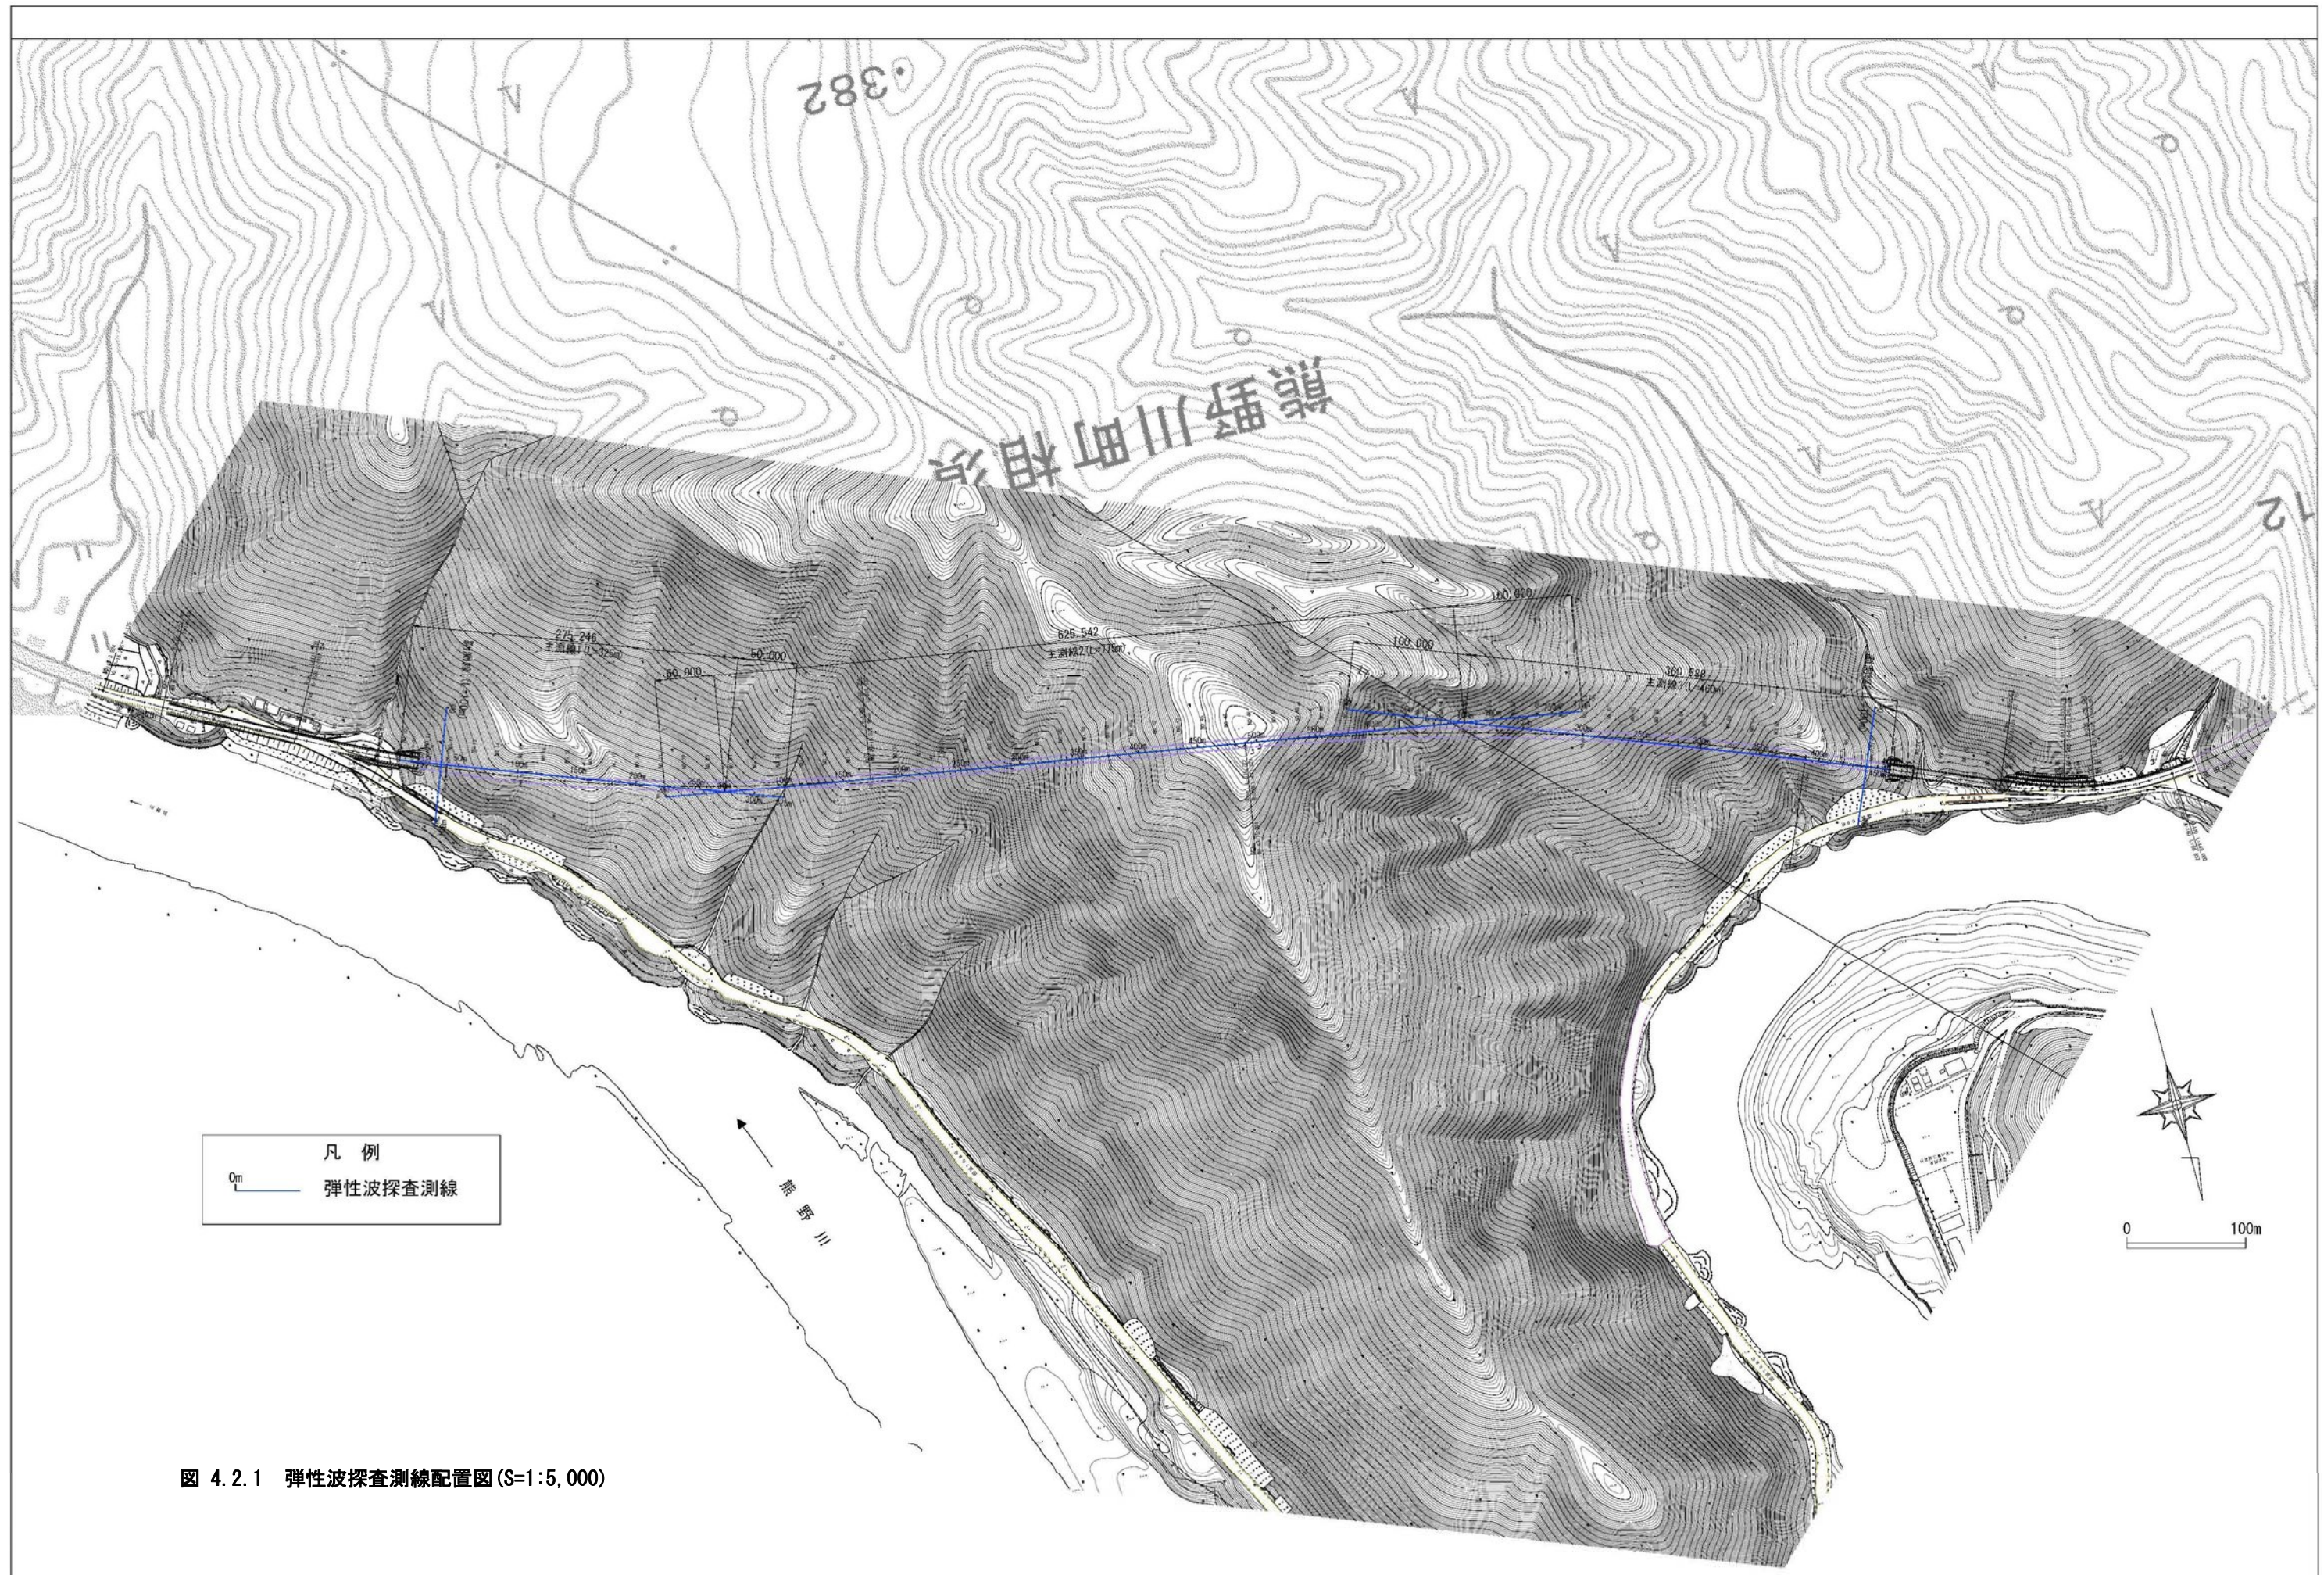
弾性波探査測線配置図 (S=1:5,000)
